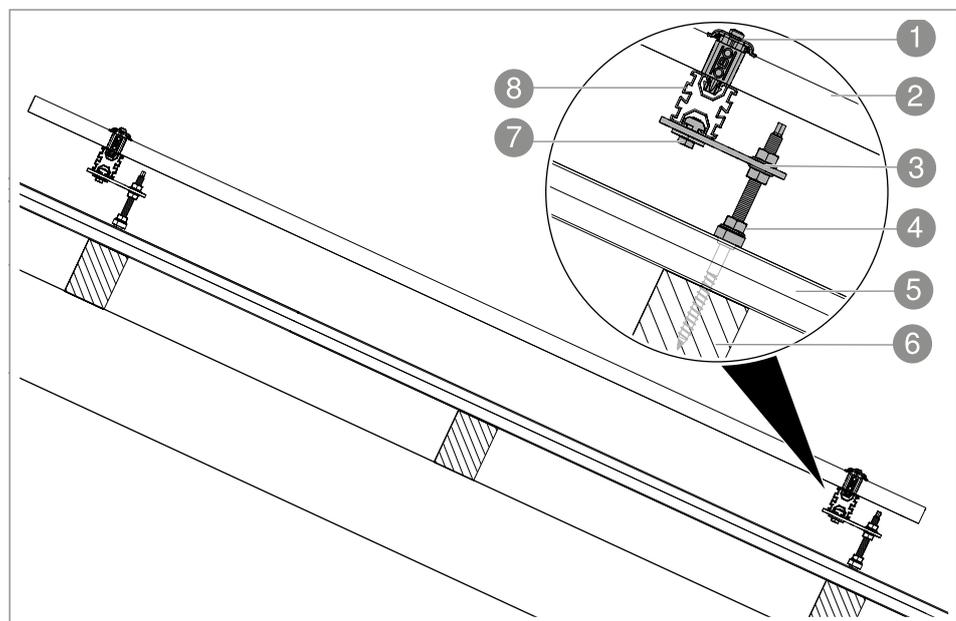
Systemaufbau Trapezdach Seitenansicht
